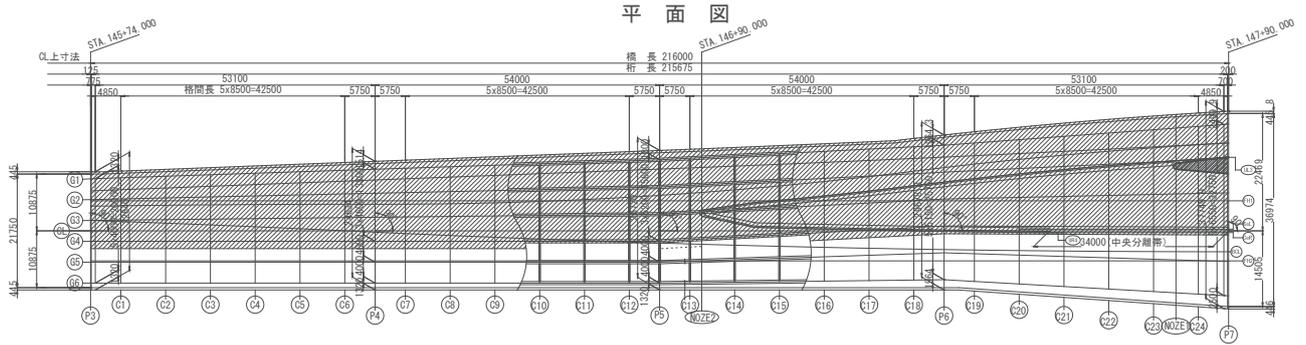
津田高架橋 平面図（ハッチングは暫定形範囲を示す）
